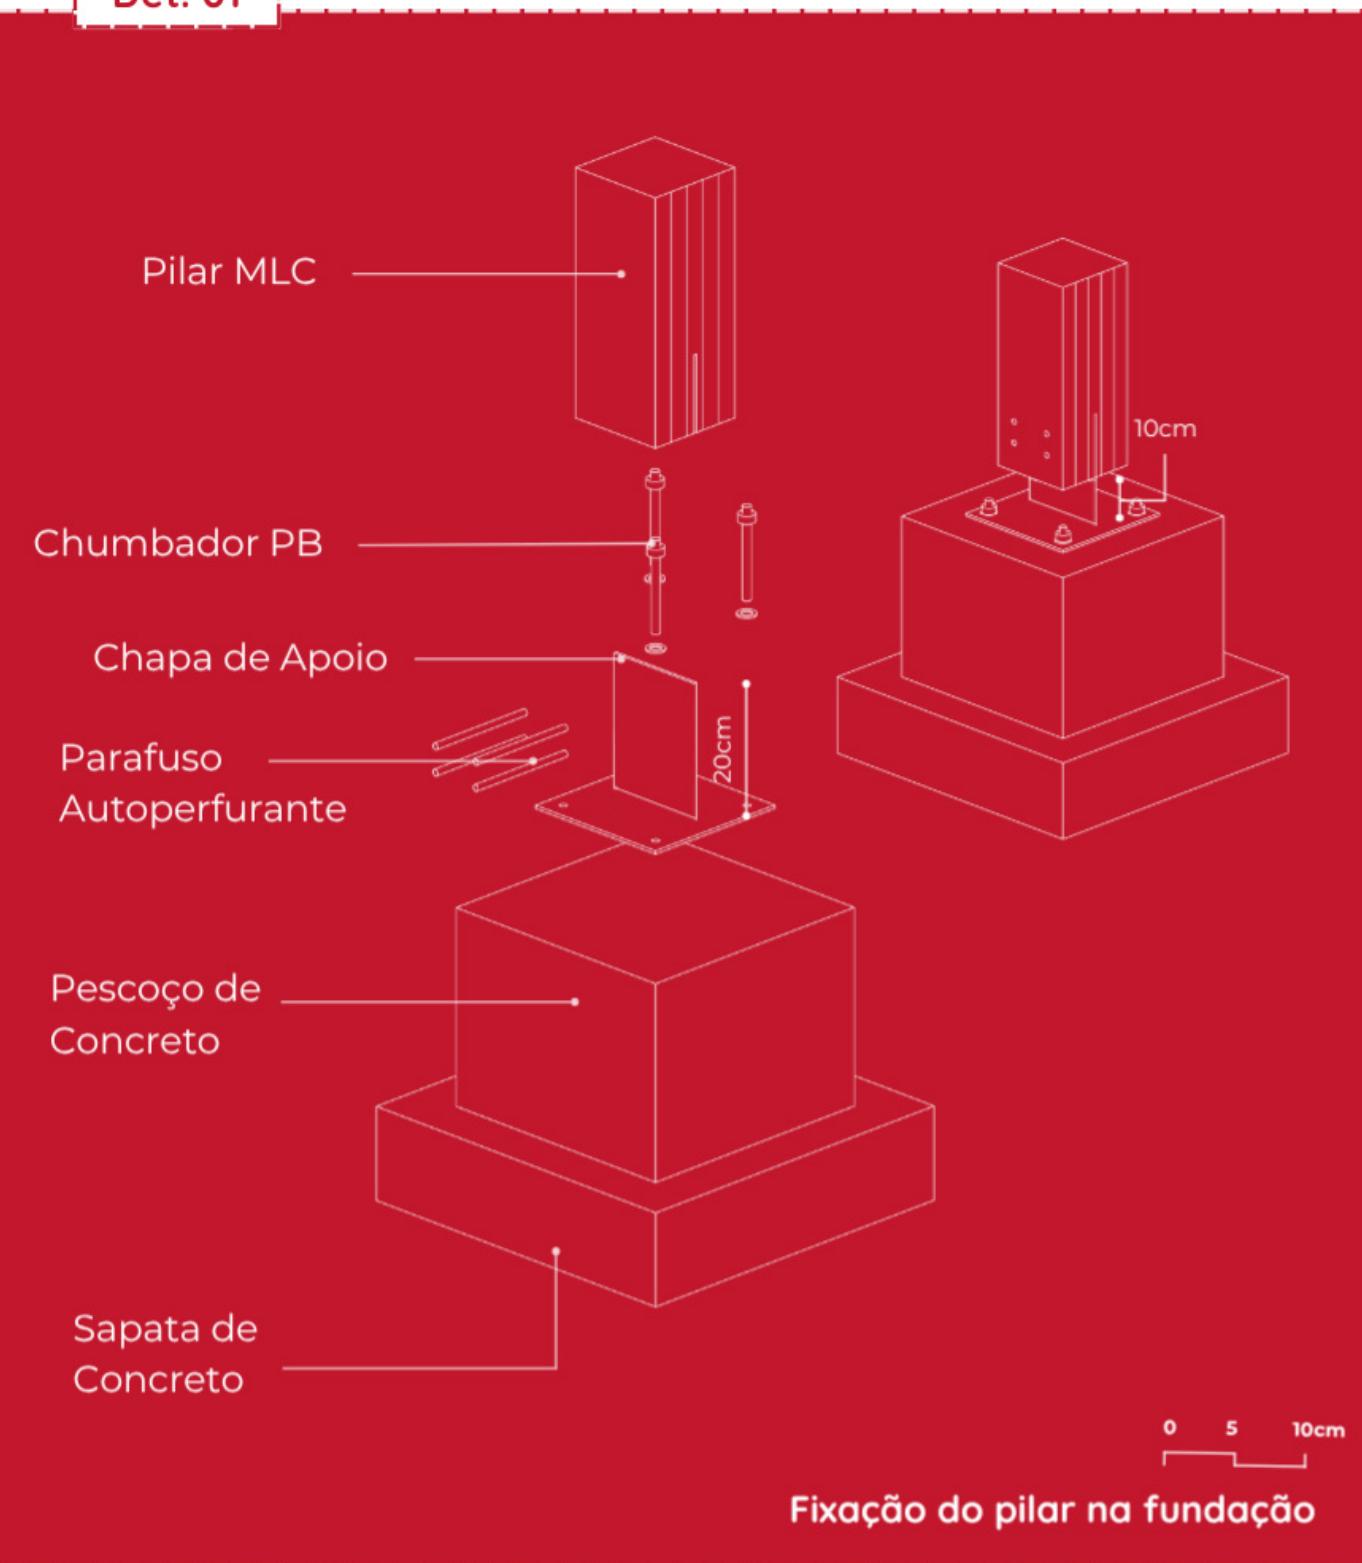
Detalhes construtivos da estrutura em Madeira Laminada Colada (MLC). Elaborado pela autora, 2025.
